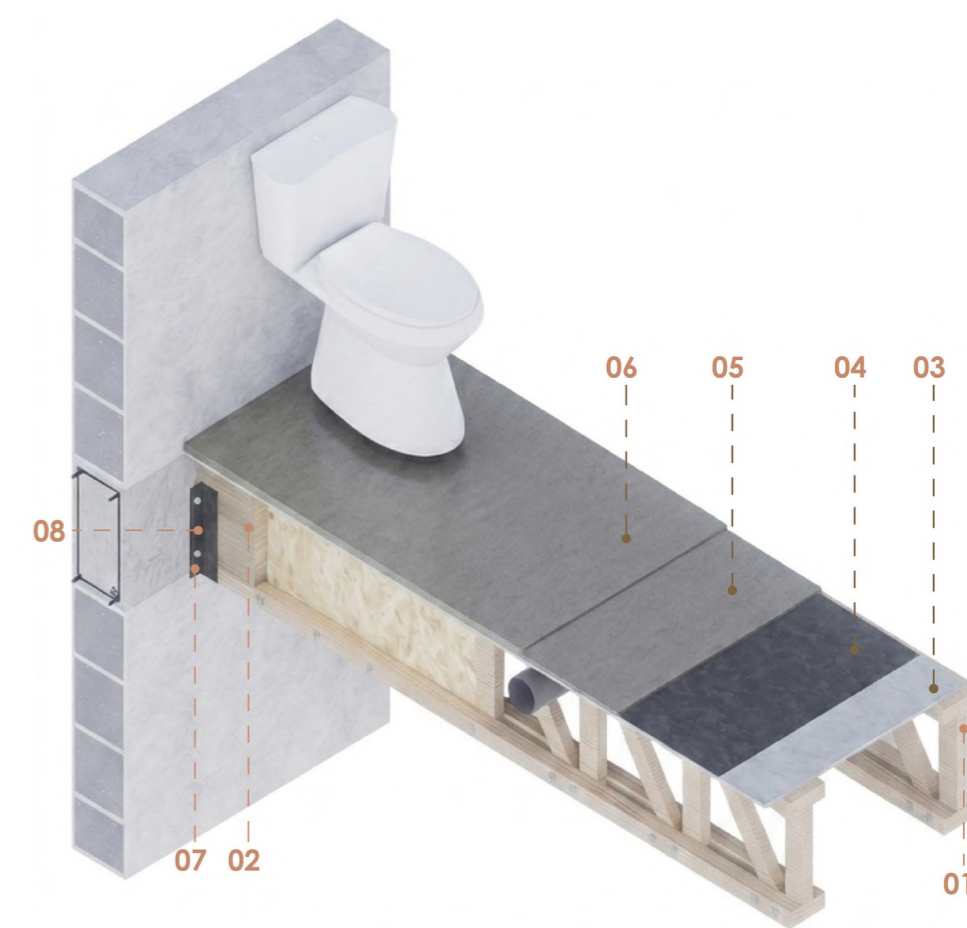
Render de entrepiso mixto I para zonas húmedas.
